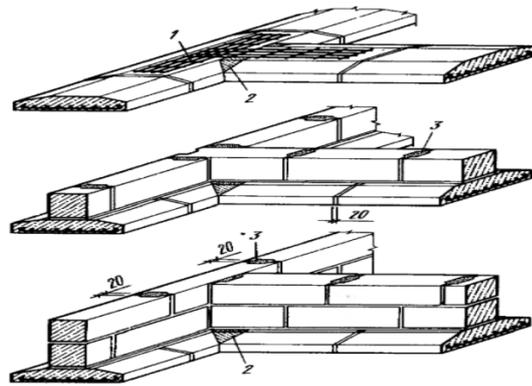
Сборные железобетонные ленточные фундаменты
